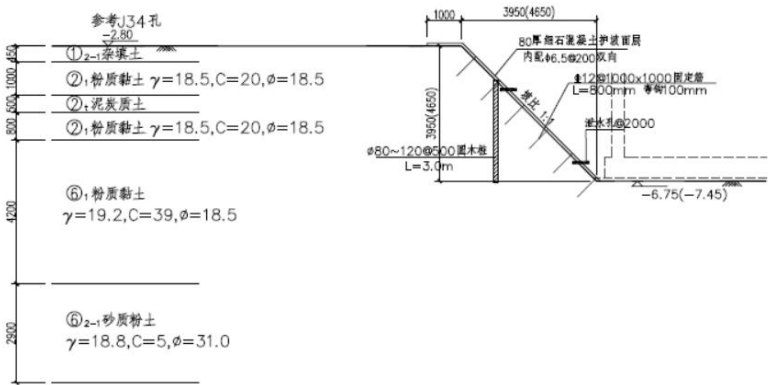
嘉善地块基坑开挖竖向布置示意图
